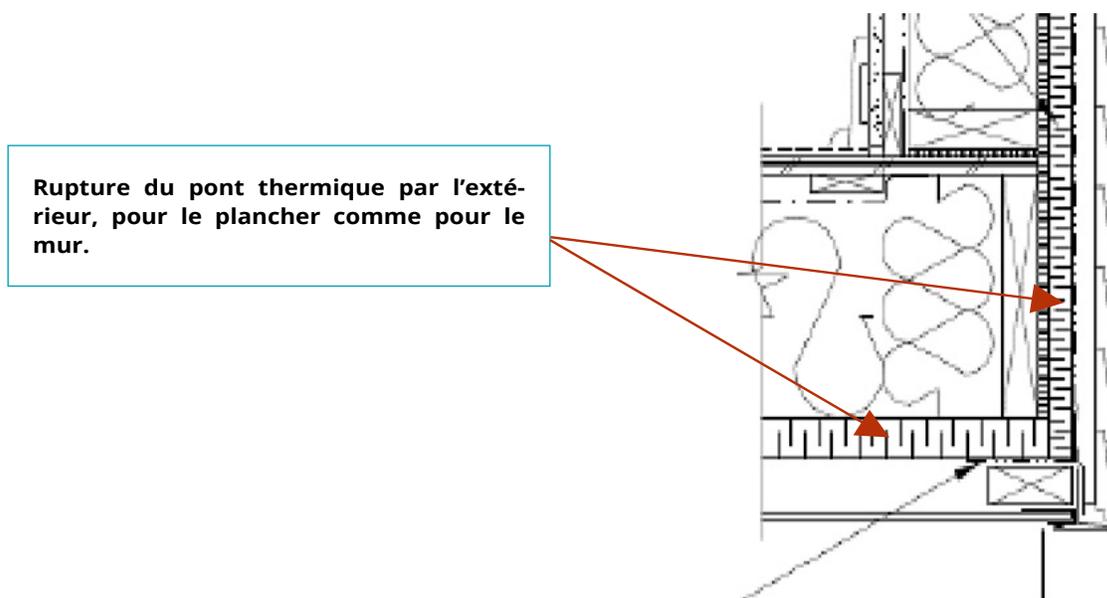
DÉTAIL TYPIQUE DE LA JONCTION ENTRE UN MUR ET UN PLANCHER / SOURCE : SHQ
